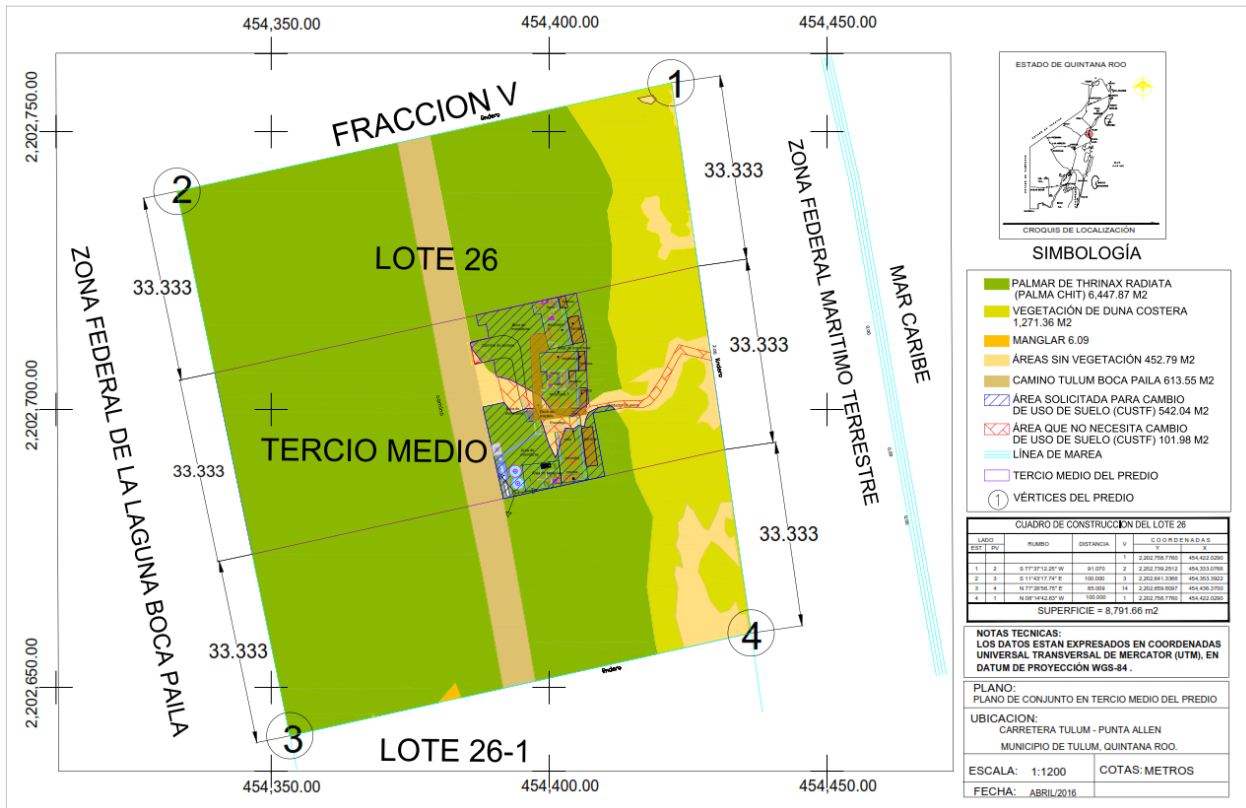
Plano de conjunto del proyecto (ver plano 1 en anexo planos).
